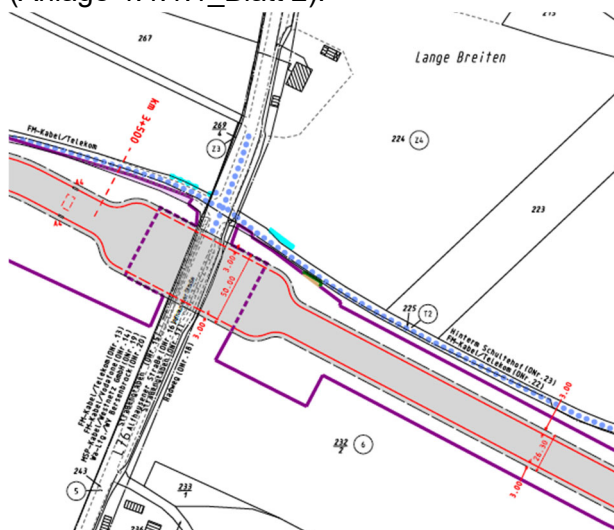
Bl. 4260 Ausschnitt Zufahrt BE-Fläche Alfhauser Straße
